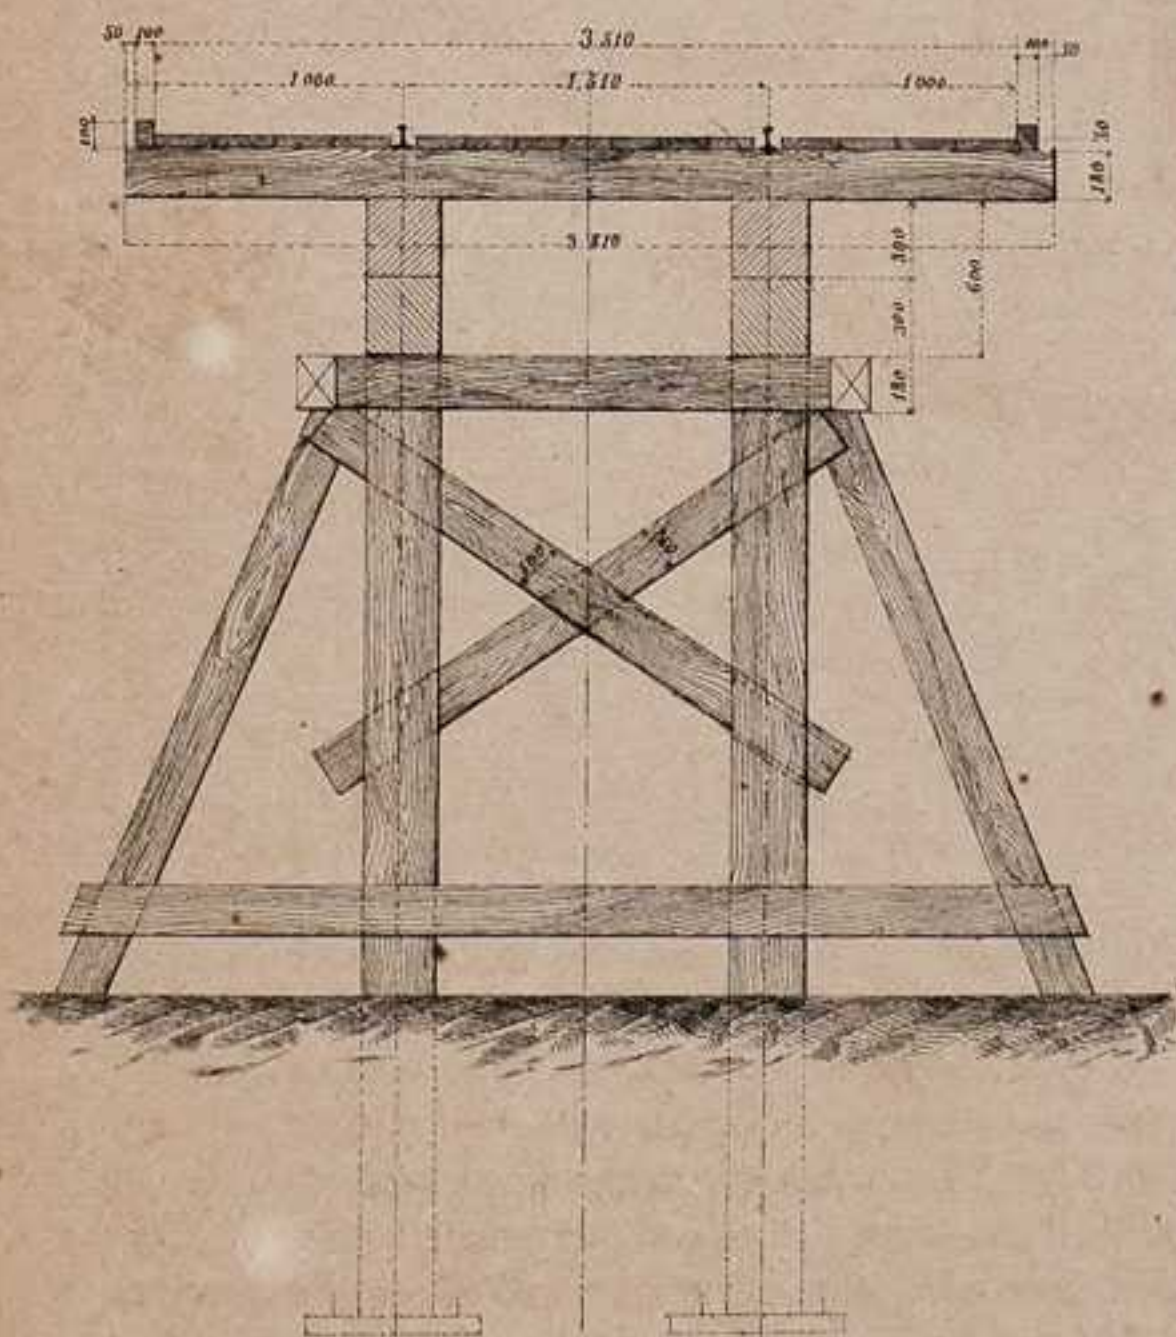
Sezione trasversale del ponte di servizio. Scala di 0m 02 p. metro.
